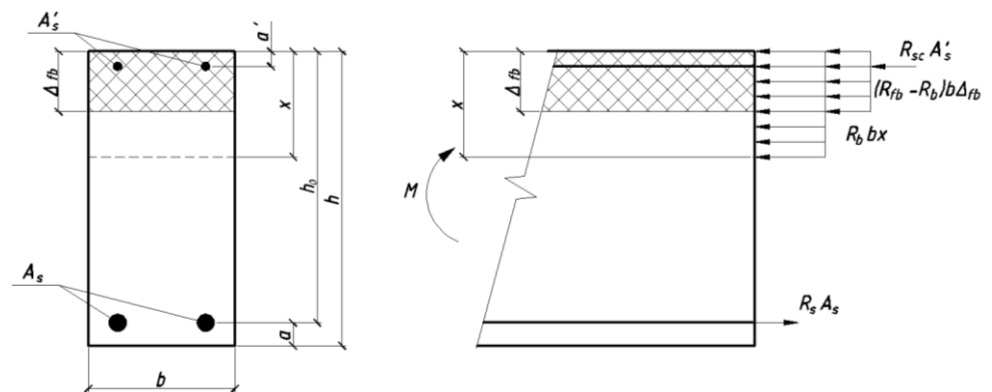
Расчетная схема нормального сечения изгибаемого сталефибробетонного элемента в абсолютных единицах
